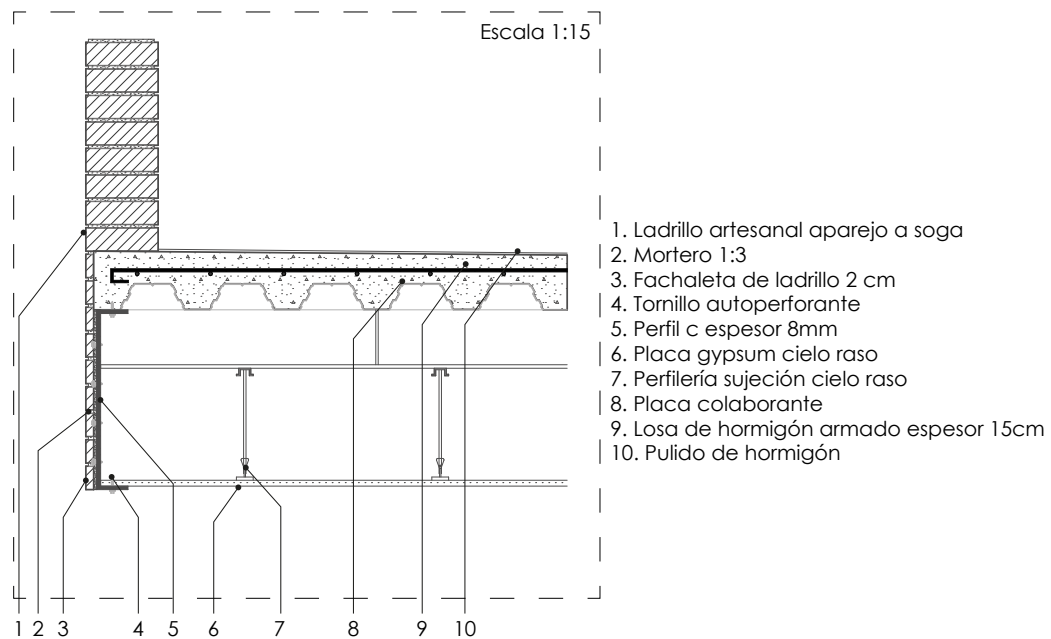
Detalle constructivo losa entrepiso y mampostería de ladrillo
